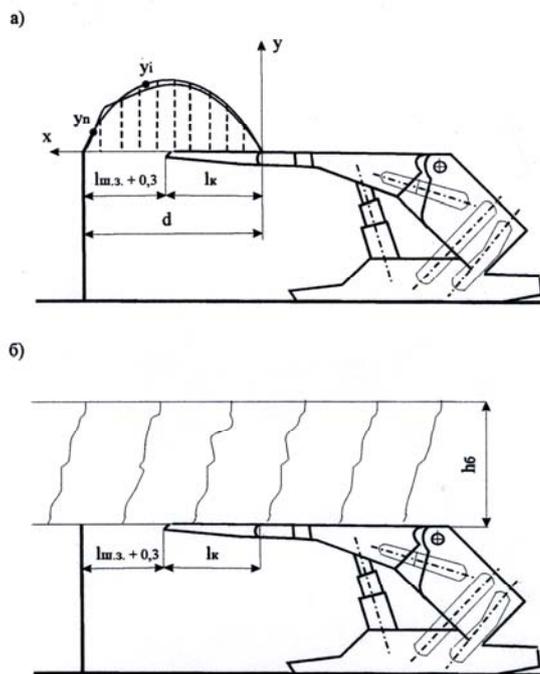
Схемы нарушения сплошности нижних слоев кровли: а) сводчатая; б) блочная
